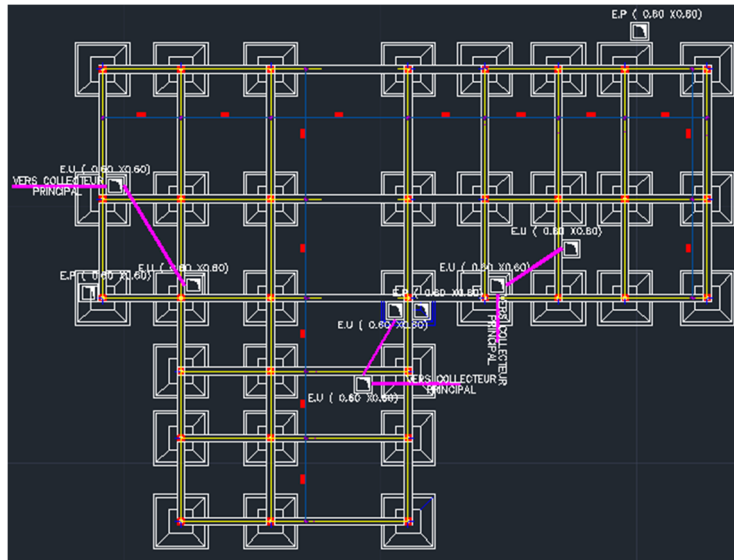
Plan de fondation (Disposition des semelles isolées).
